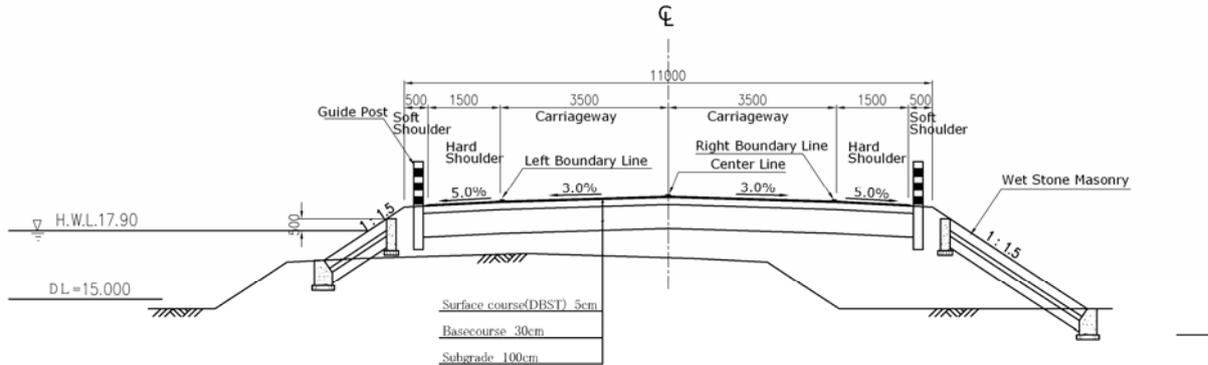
ダンダヤ橋取付道路標準断面図
